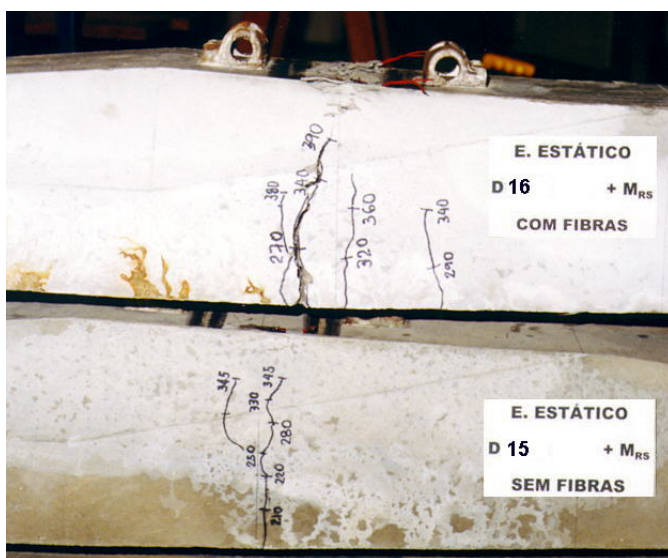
Configuração das fissuras na ruptura, dormentes modificados D15 e D16.
